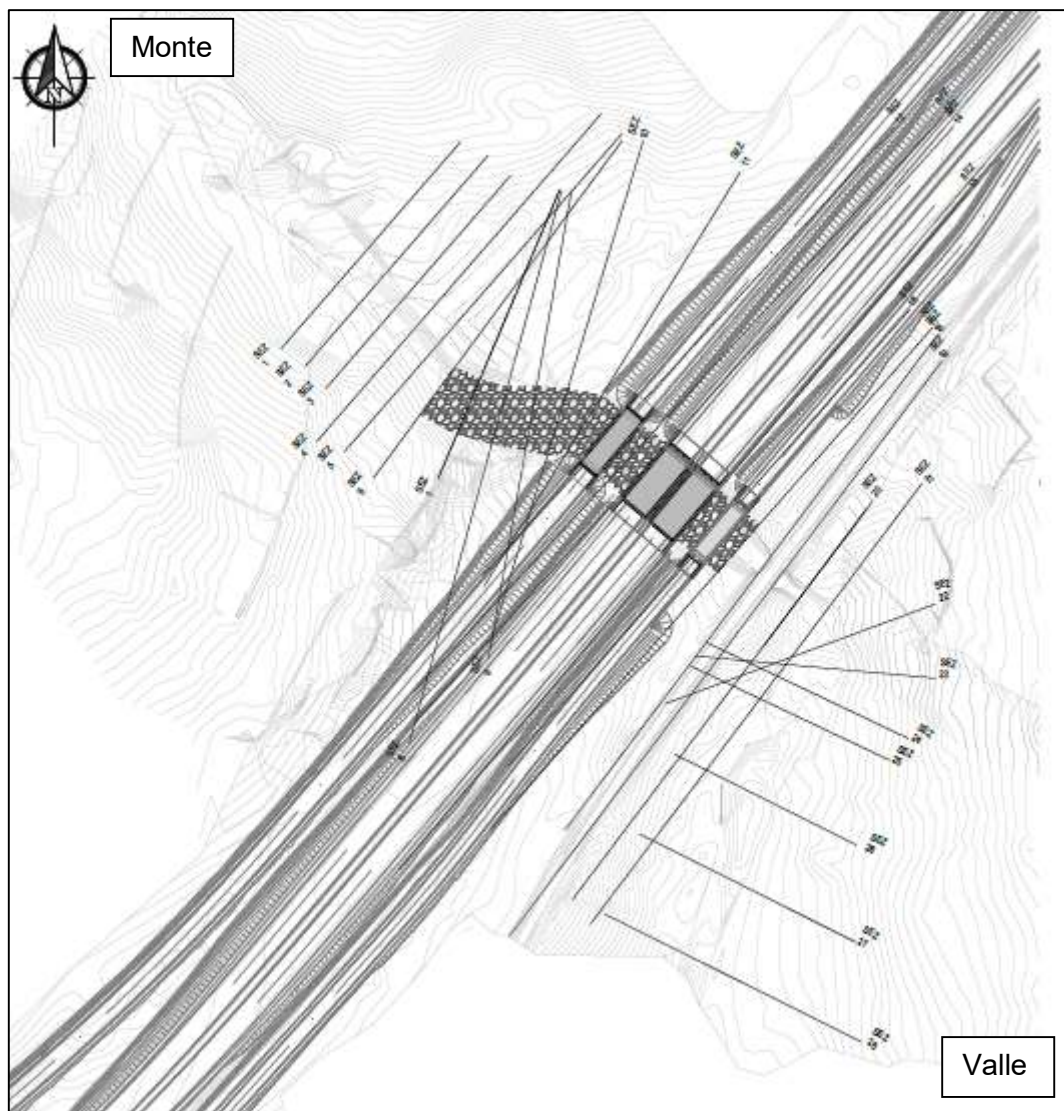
Stralcio planimetrico di inquadramento dell'attraversamento sul Riu Pitziu tramite ponticello idraulico $L=23.2$ m
